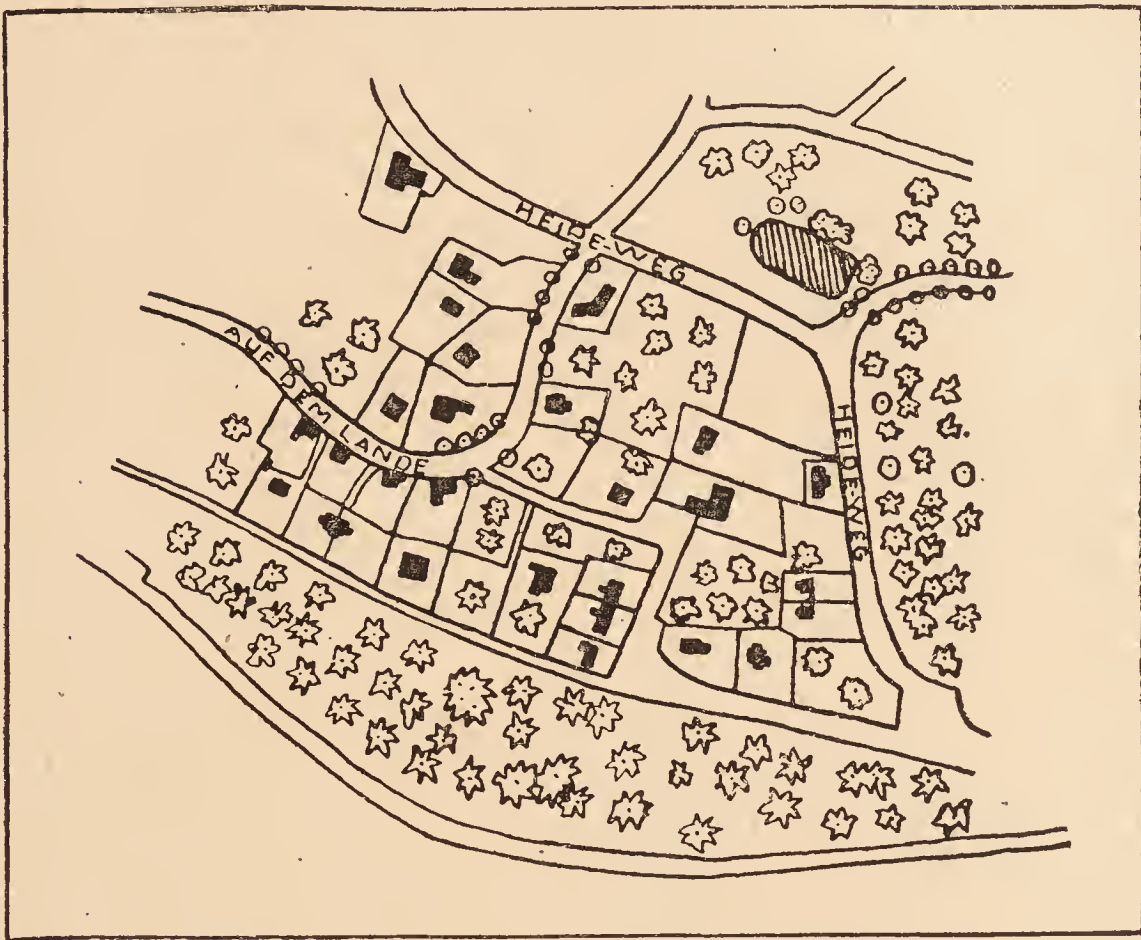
Lageplan eines Teils der Gartenstadt Hellerau. 1:5000.
